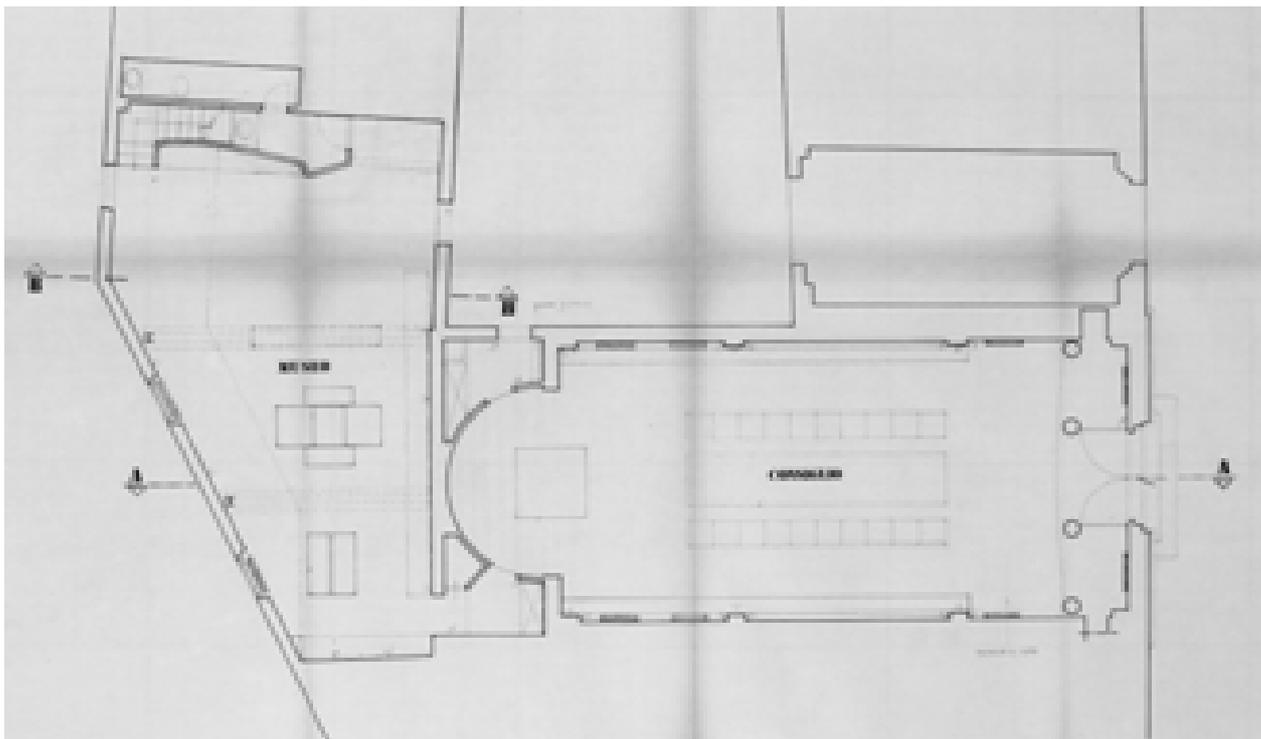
Pianta quota +0,00 – Stato di progetto – 24/02/1981 (AABS-94.044)
